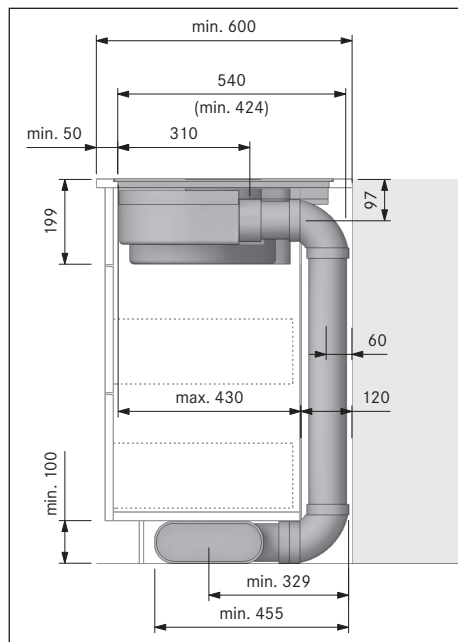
Medidas de montaje para extracción al exterior, profundidad de la encimera 600 mm
